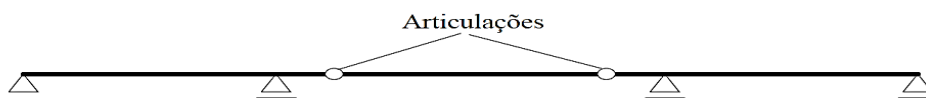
Esquema estático de ponte em viga Gerber.
